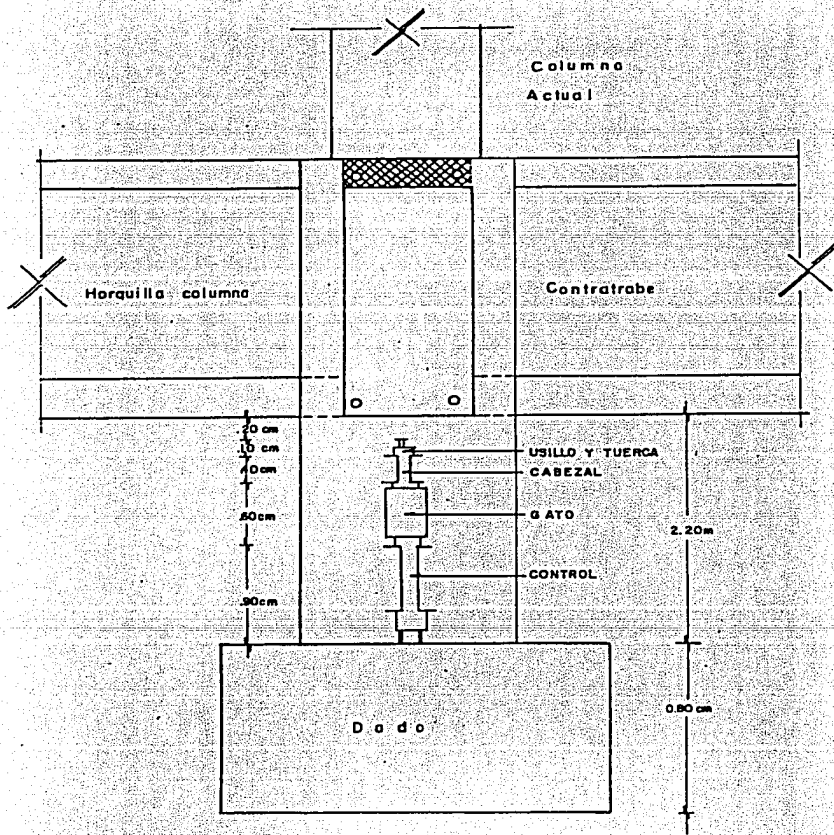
PROYECTO DEL ESPACIO LIBRE Y DE LA EXCAVACION PARA LA NUEVA CIMENTACION EN CADA COLUMNA
